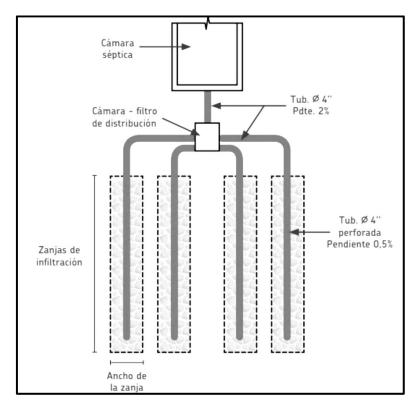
Vista en planta, partes de las Zanjas de Infiltración.
